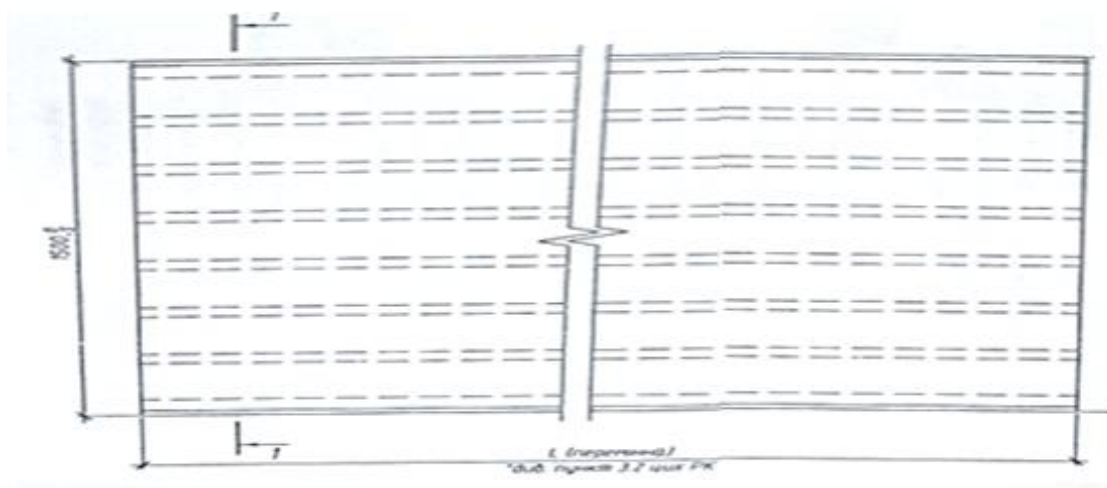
Загальний вигляд багатопорожнинної плити ПБ 63.15.22
